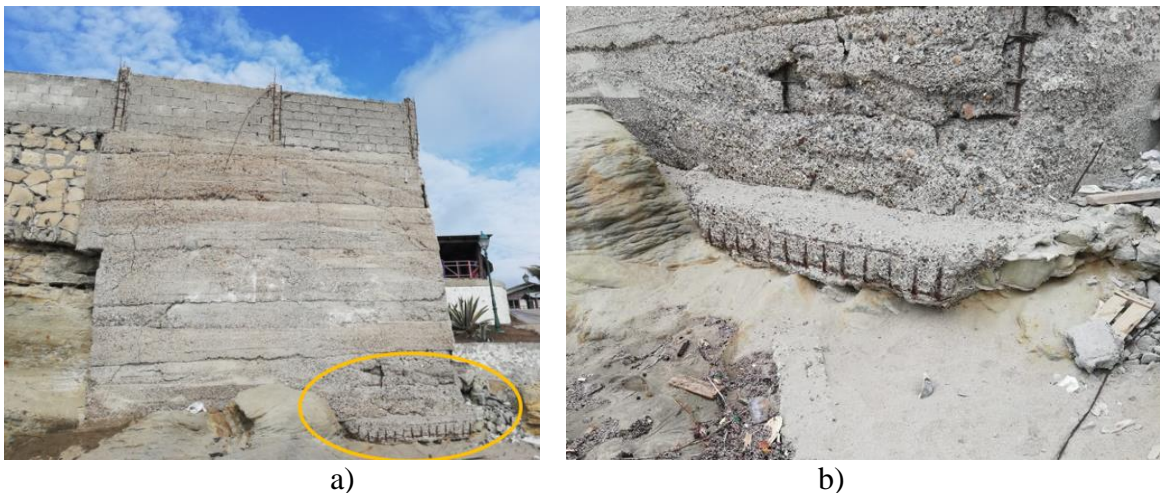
a) Vista de la fachada posterior ubicada frente al mar. b) Estructura de cimentación expuesta, con importante deterioro del hormigón de recubrimiento y armadura corroída
